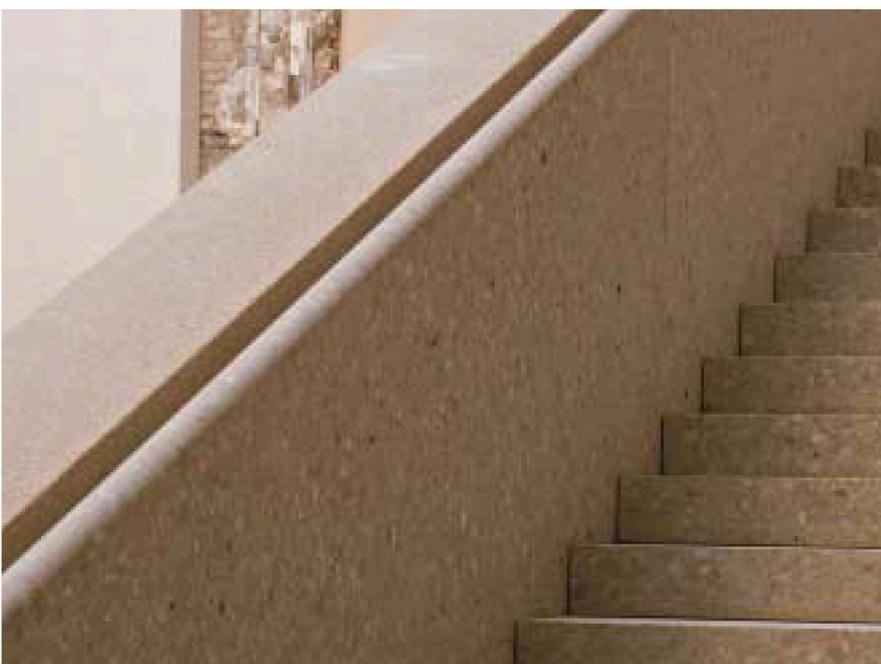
Brüstung – Handlauf – Stufen; Marmorbeton geschliffen
